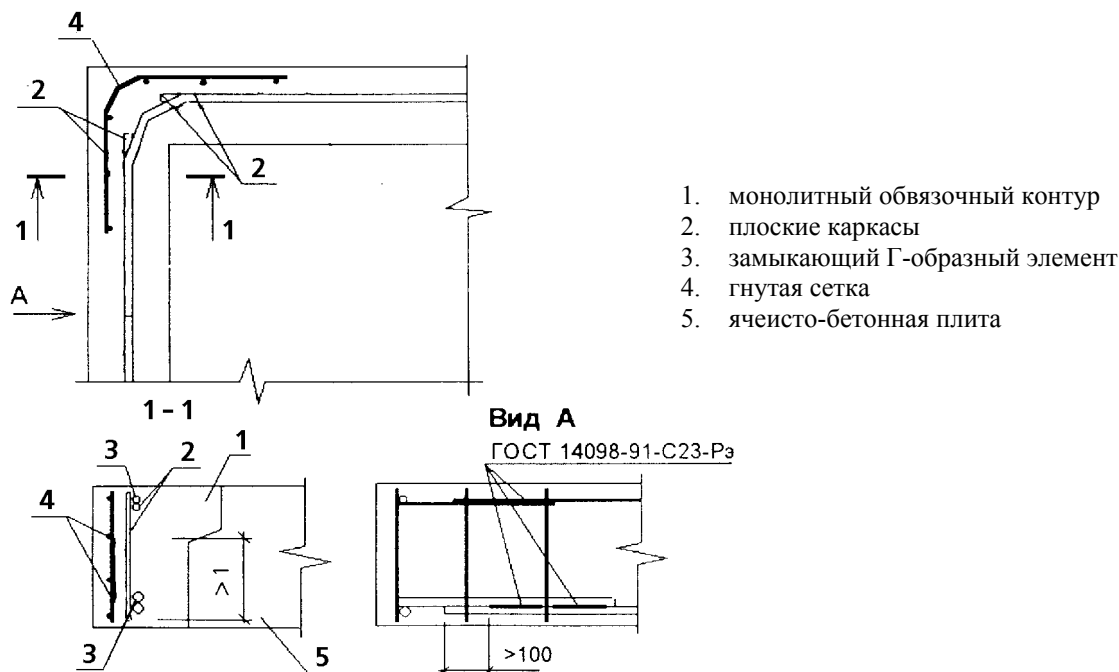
Опираие плит сборно-монолитных перекрытий на наружные стены
